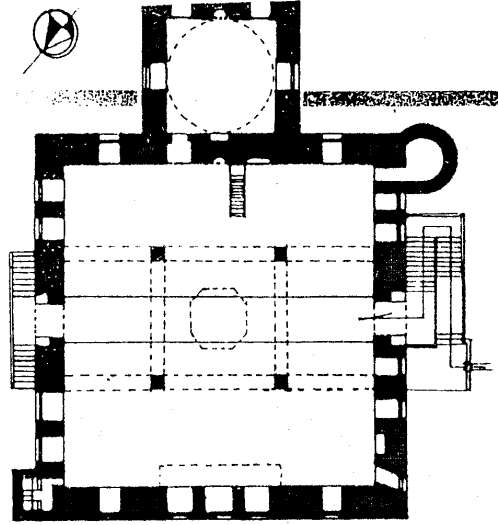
مسقط أفقي لقبة الشيخ
